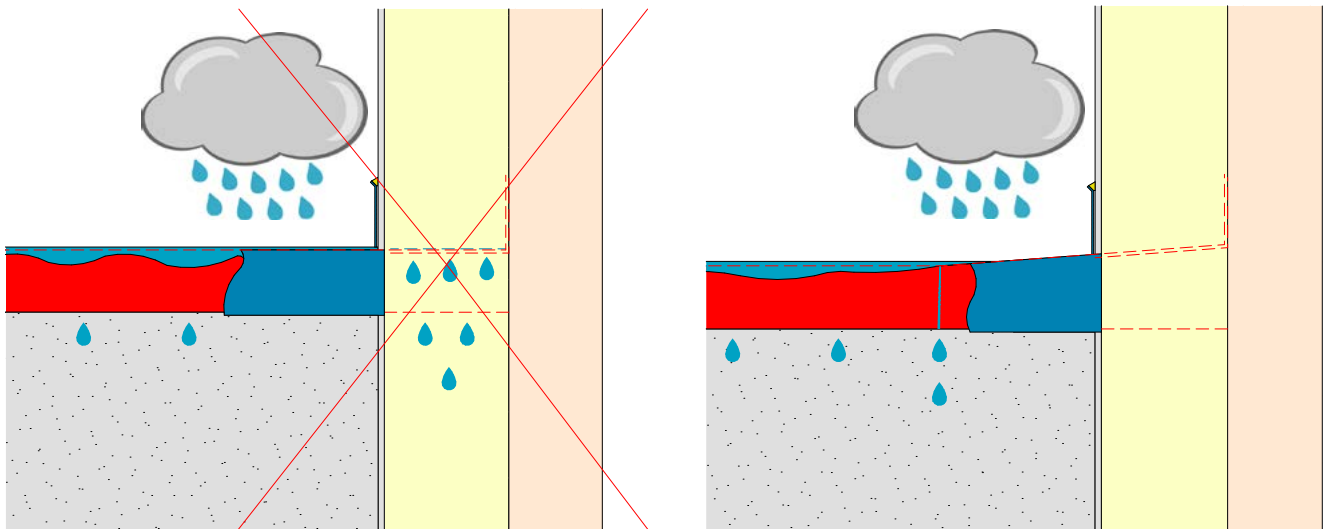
Schnitt Dachrandabschluss mit mindestens 25 mm höher ausgeführten Wandanschluss
